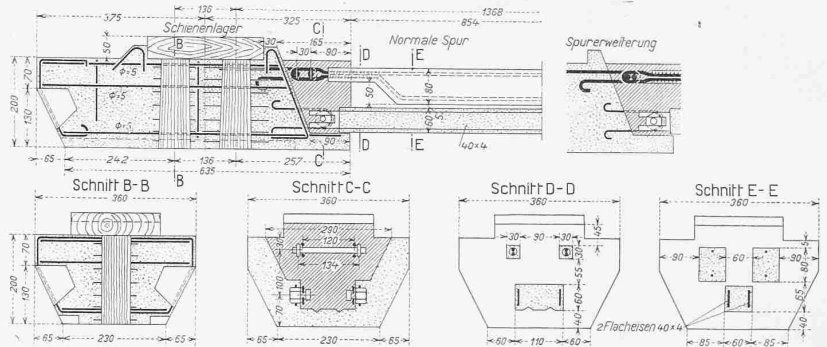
Längsschnitt und Querschnitte durch die Eisenbeton-Schwelle. — Masstab 1:15.
